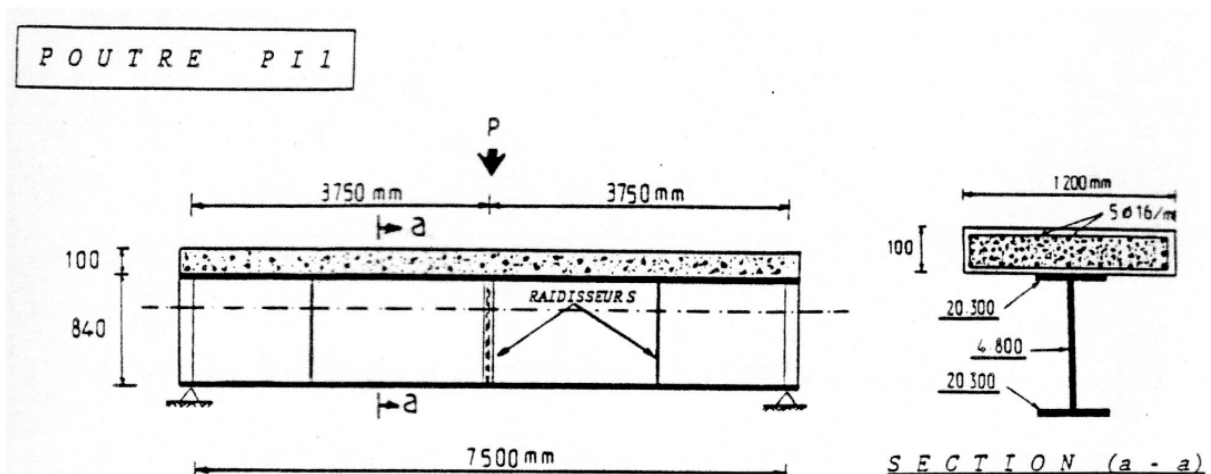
Poutre isostatique à sections mixtes PI1
